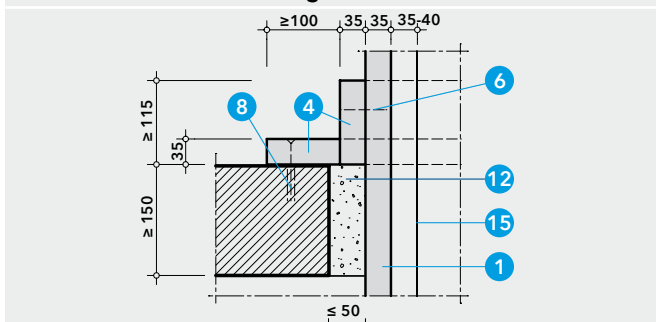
Detail F - Abhängung und Auflagerung des Stahlblechkanals
